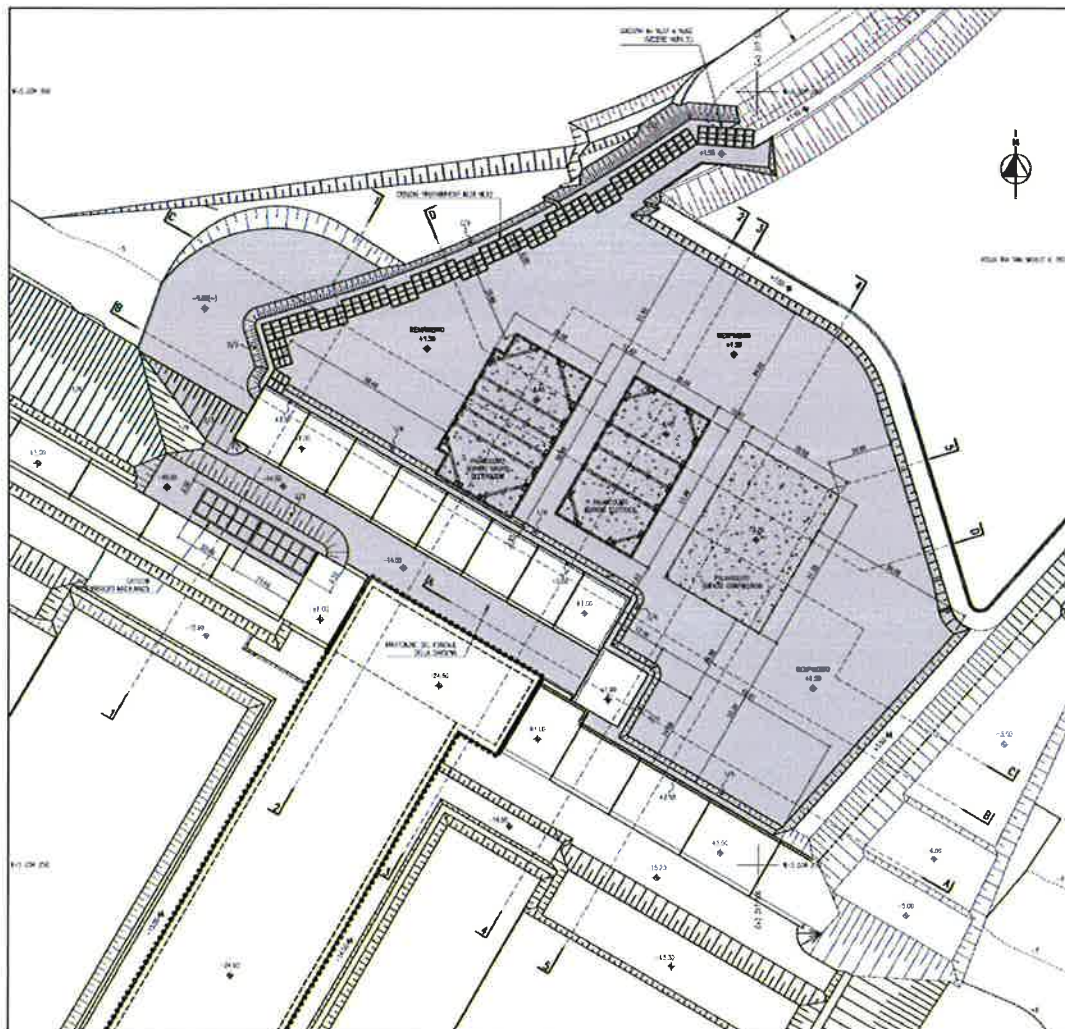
SPALLA NORD, PLANIMETRIA DELLE OPERE DELLA TERZA WBE DELLA SPALLA NORD
